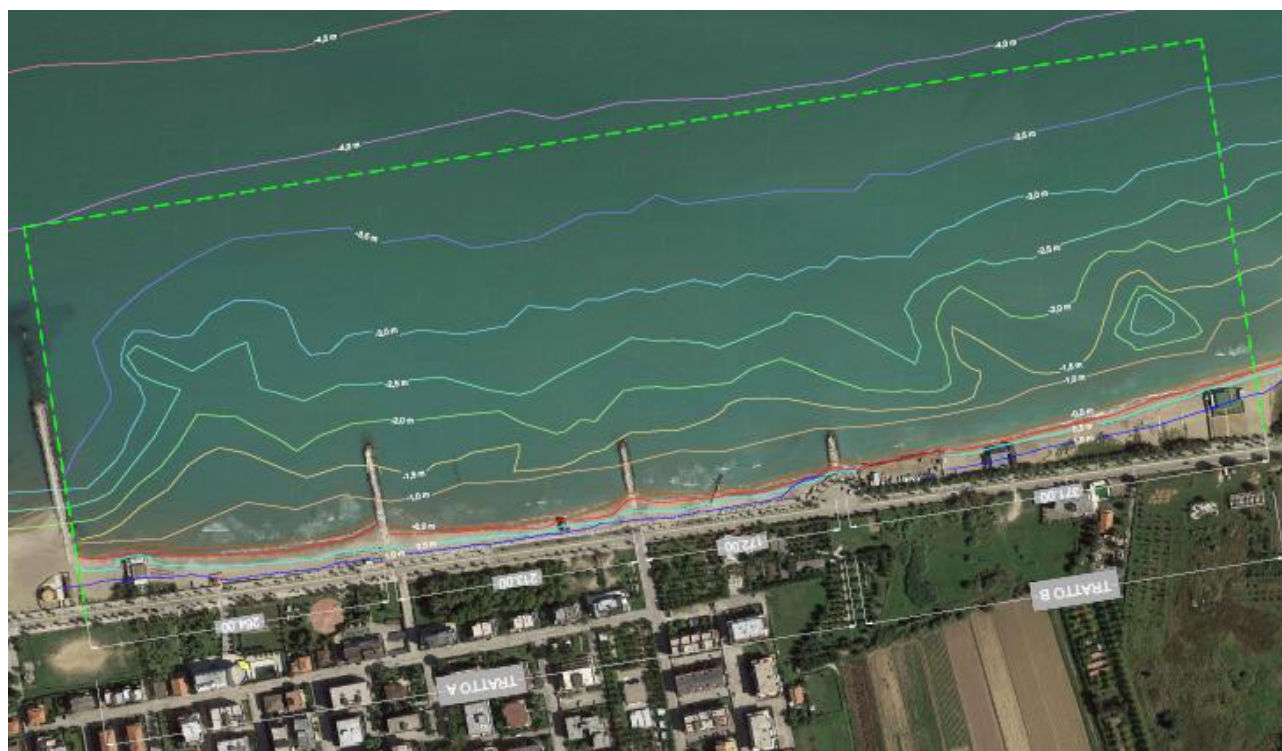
Estratto TAV. 10-b.2 Planimetria stato di fatto Martinsicuro Villa Rosa
